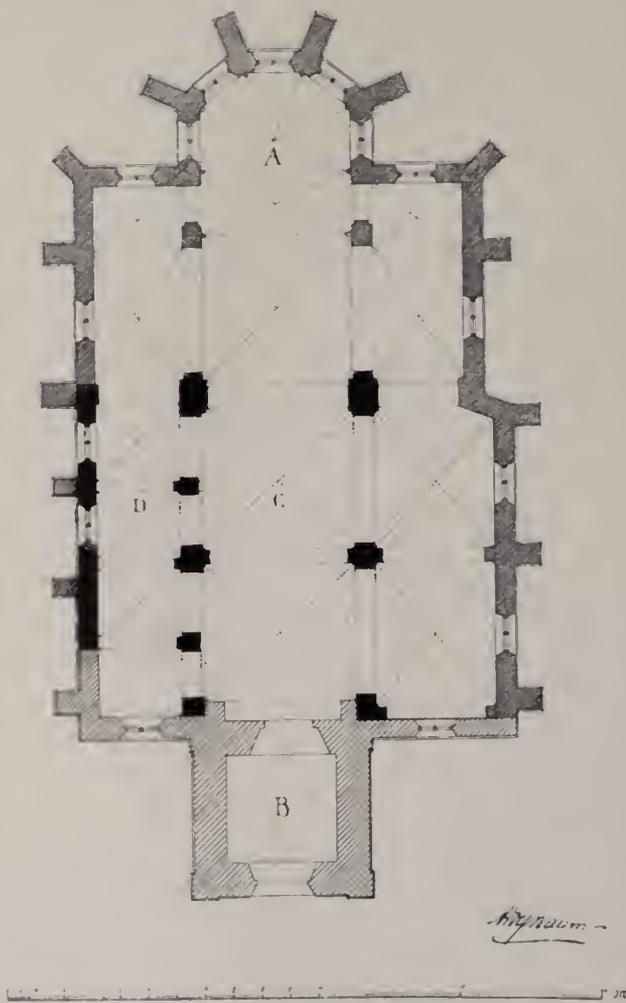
Repelen. Grundriss der Evangelischen Pfarrkirche.
